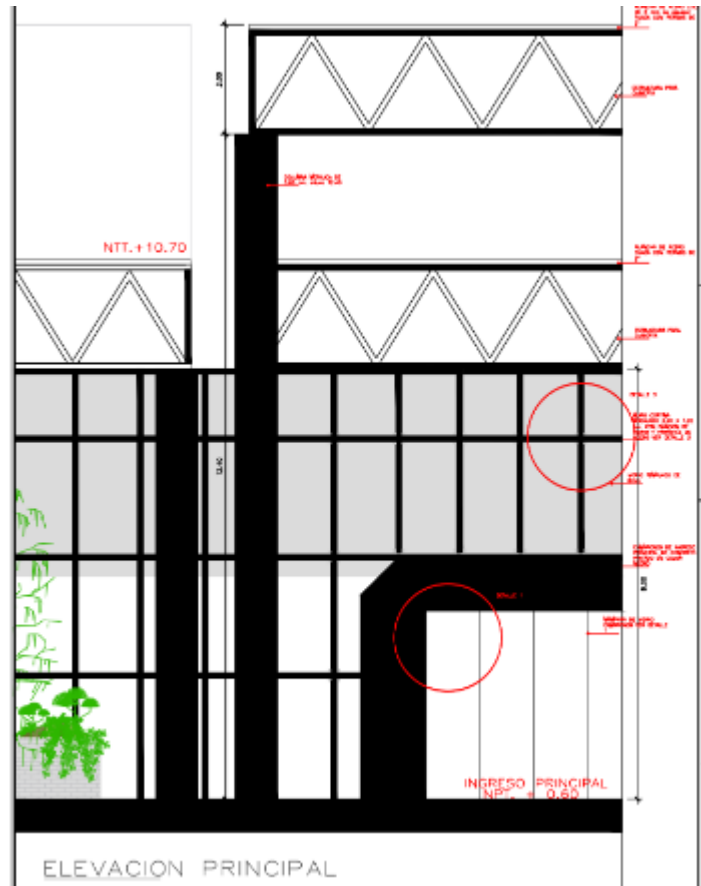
Detalles del sector elegido-Agencias-anclaje e instalación de cobertura
